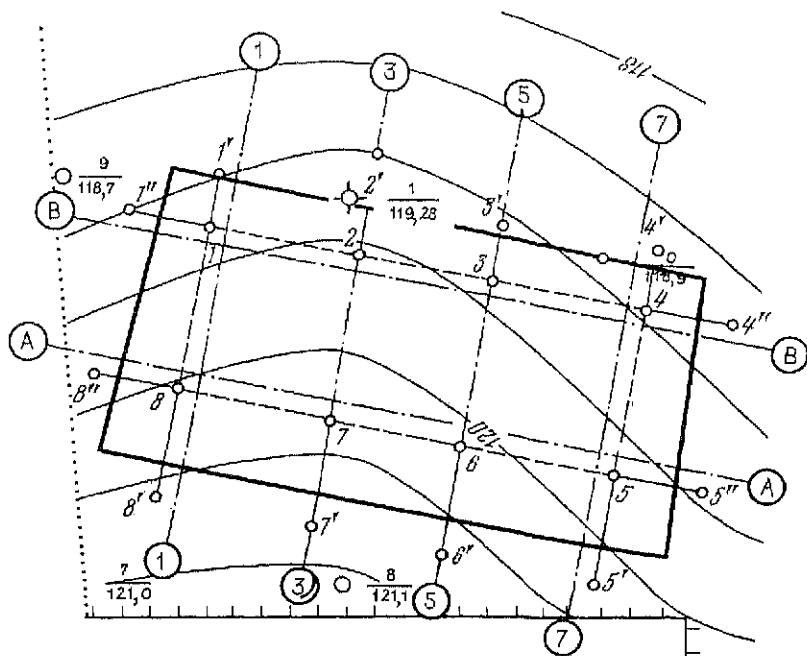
Фрагмент плана строительного участка с контурами котлована
